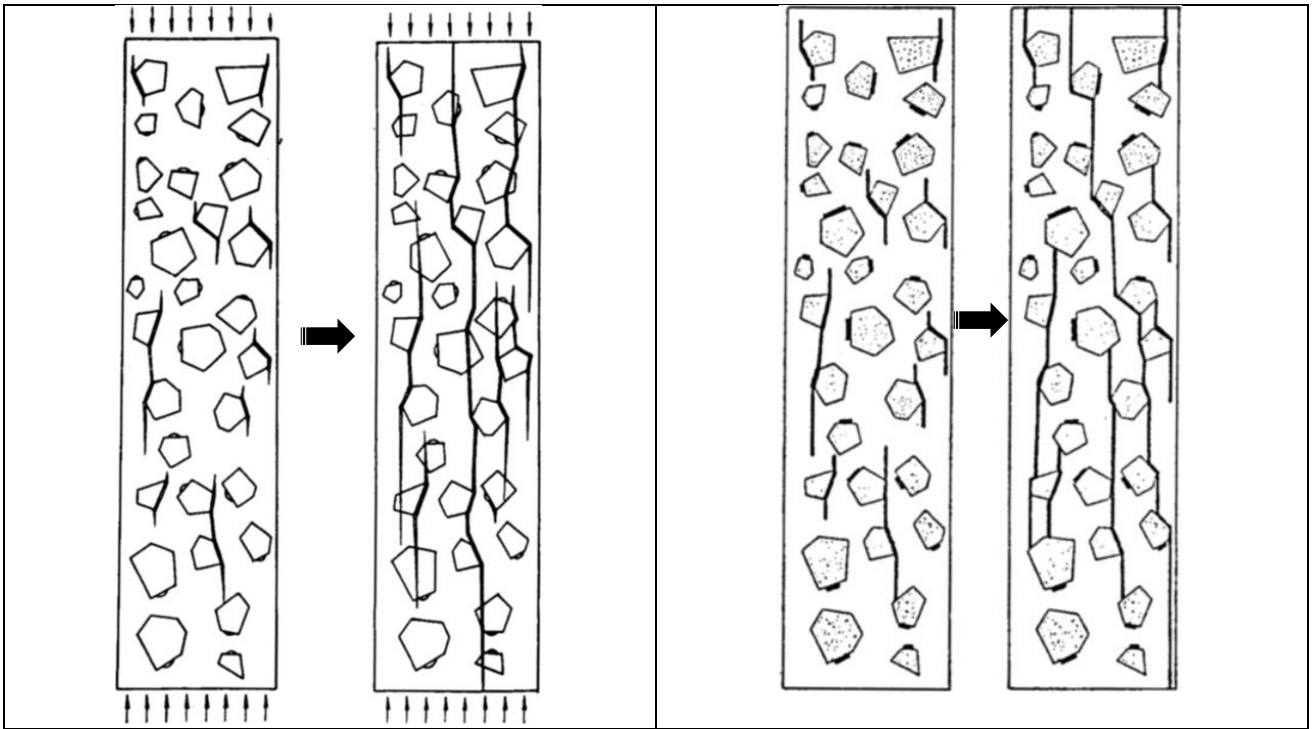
Fissuration d'un béton haute performance (gauche), d'un béton normal (droite) à faible et haut chargement en compression
